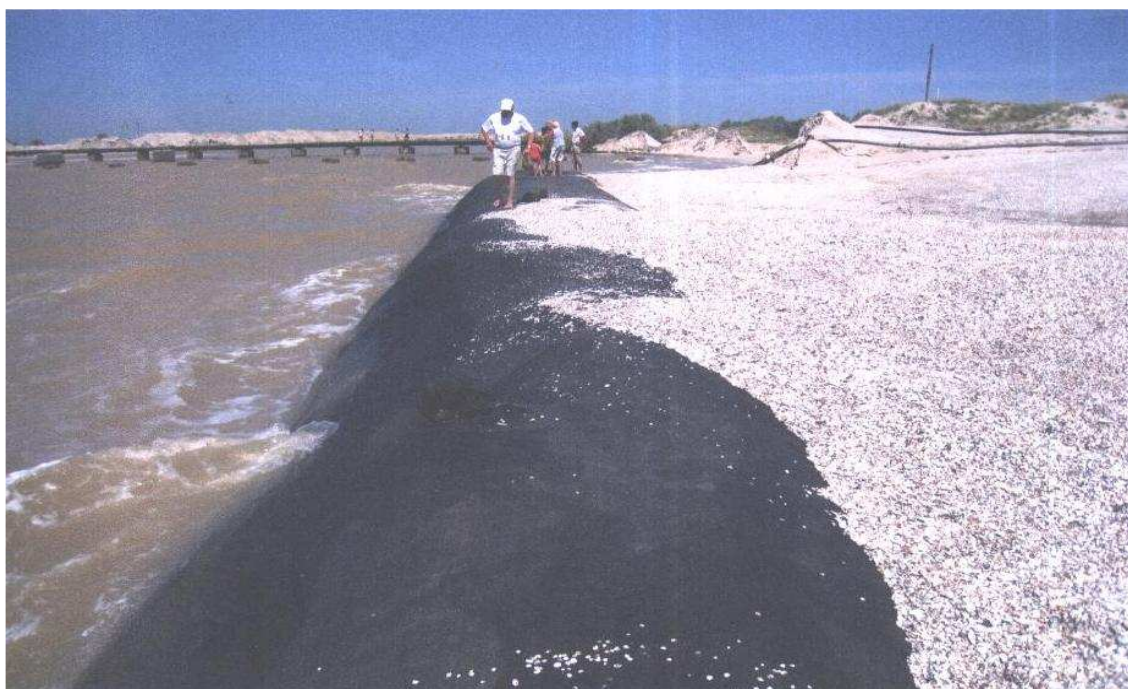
Крепление берега наполняемыми грунтом оболочками
